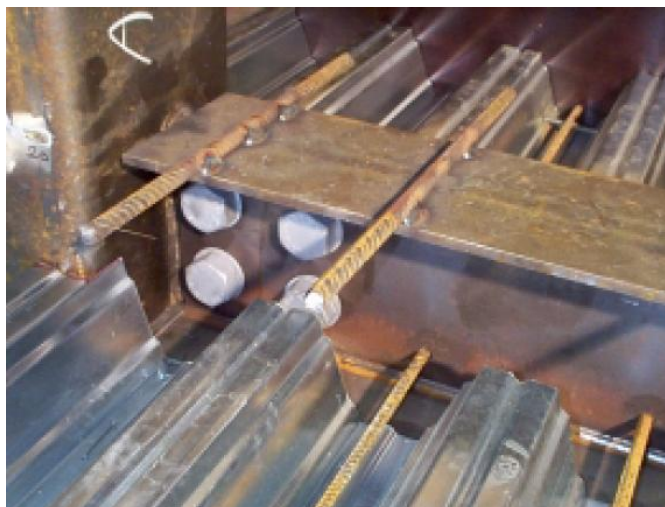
Pormenor das armaduras numa viga sem aberturas (Jurado, 2008).
